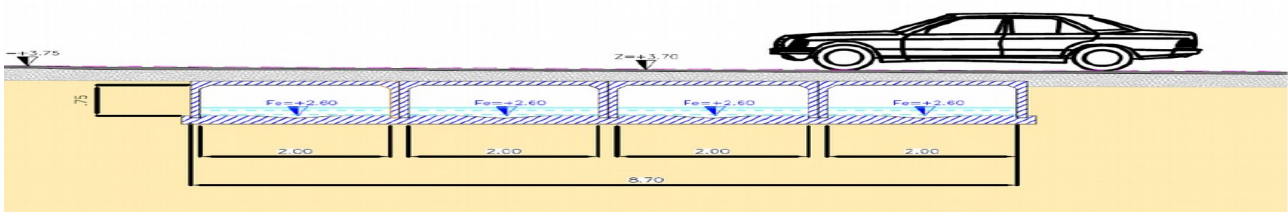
Coupe de l'ouvrage hydraulique n°1
